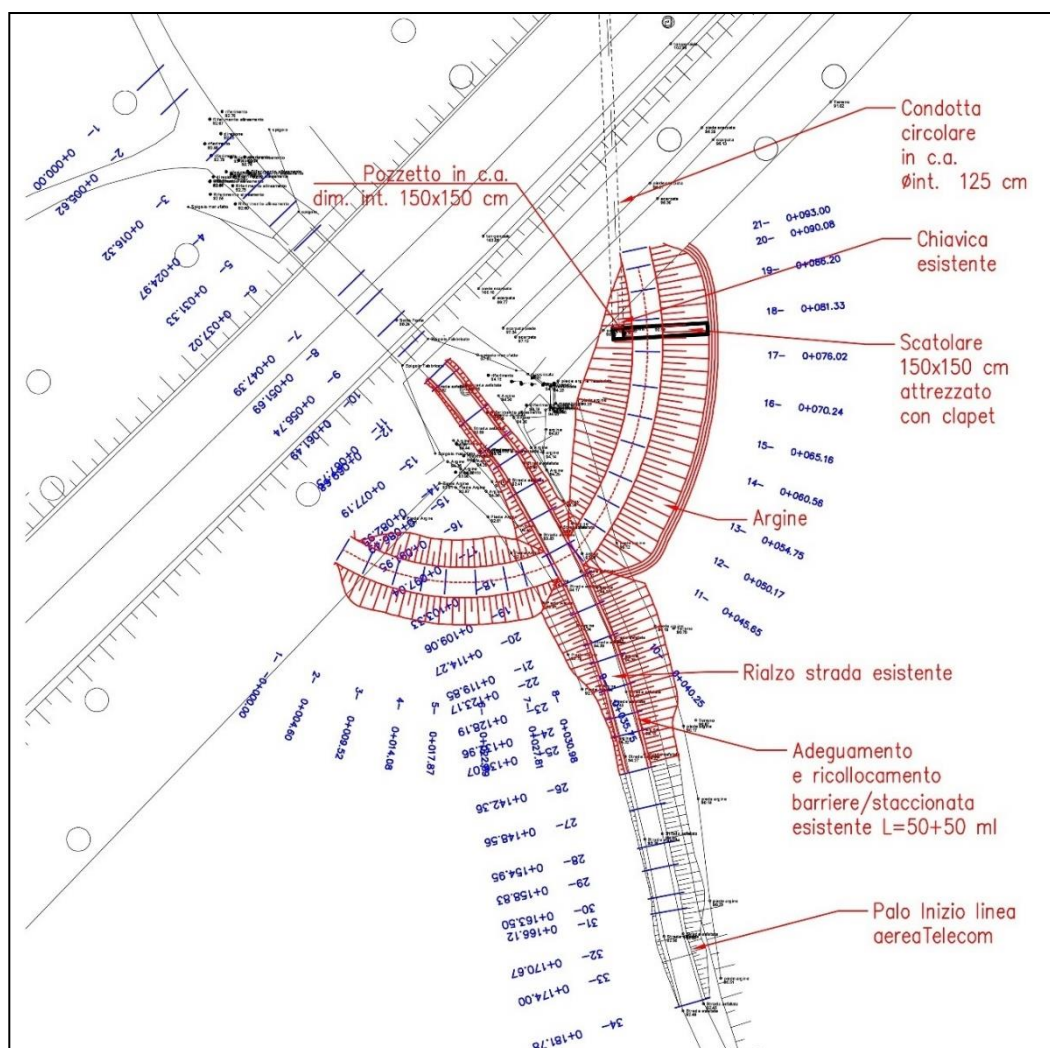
Arginatura chiusura fornice ramo sud Via del Chiozzetto – Planimetria
